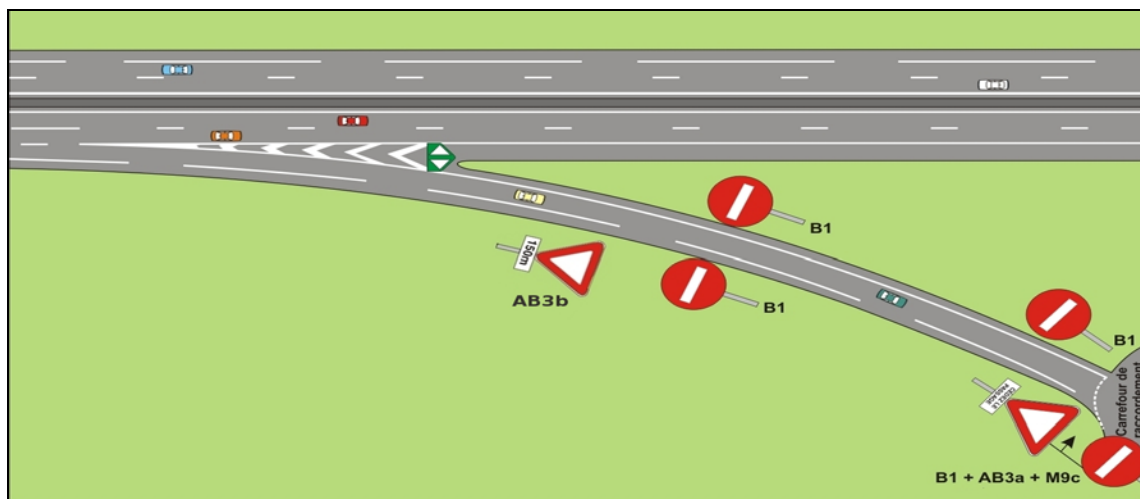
Exemple de sch ma-type d'une bretelle de sortie du point de vue r glementaire strict pour les panneaux B1
